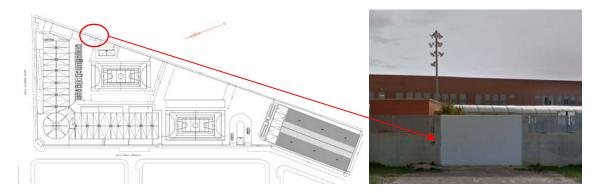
Puerta cegada en el muro perimetral en la fachada posterior, en la zona ajardinada
